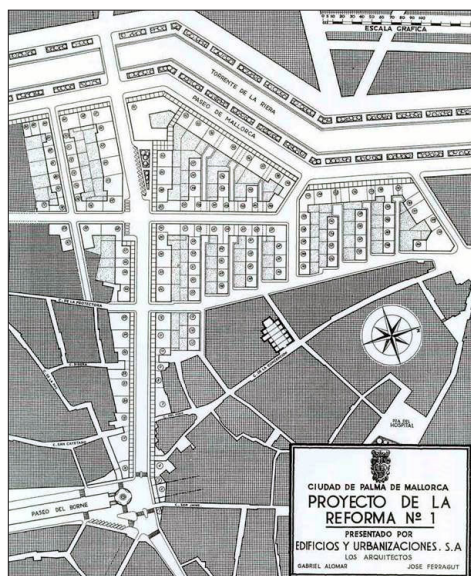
Plano y propuesta de la reforma nº 1 del Plan General de Reforma de Palma (Alomar)
